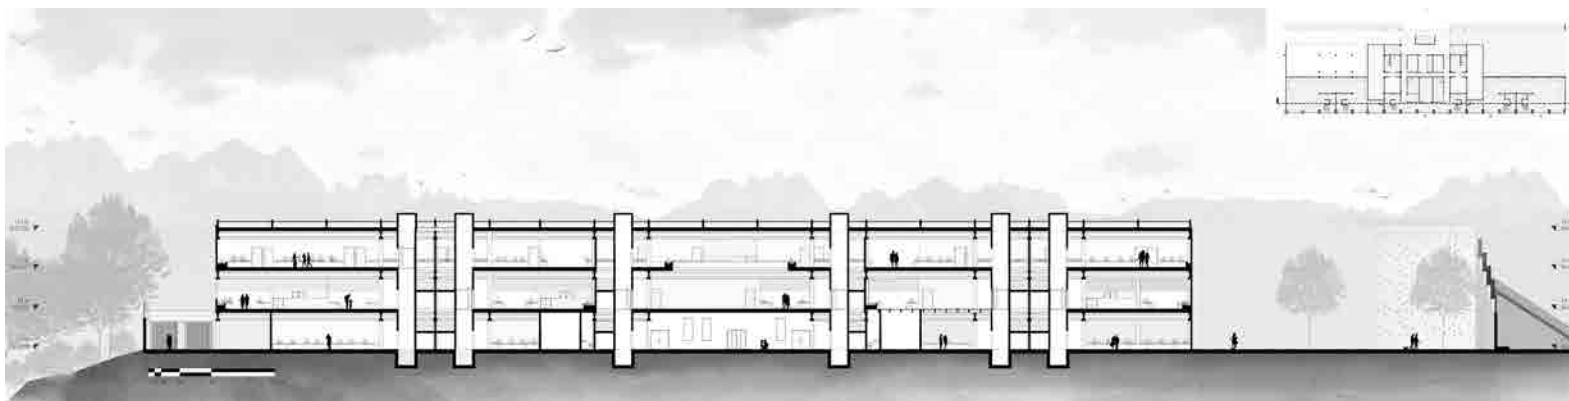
Sección longitudinal bloque derecho. Elaboración: Autores.
